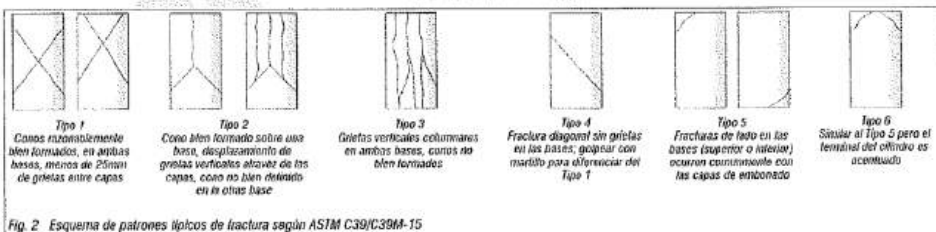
Esquema de patrones típicos de fractura según ASTM C39/C39M-15
